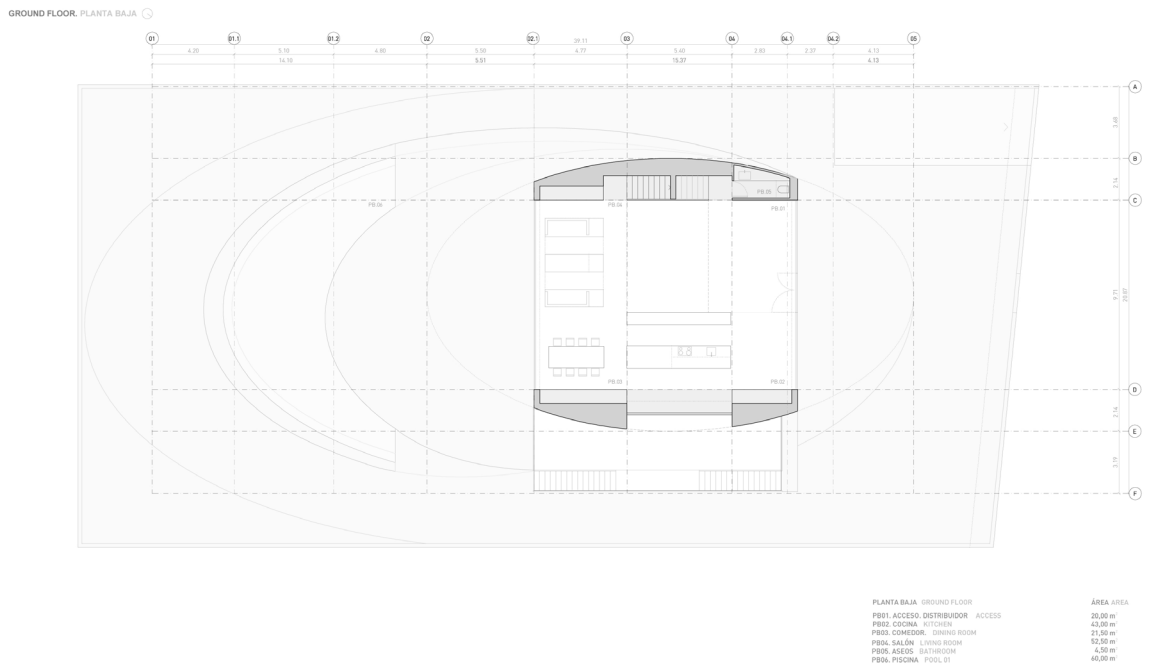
3. Plano planta baja. Fuente: Fran Silvestre Arquitectos.
